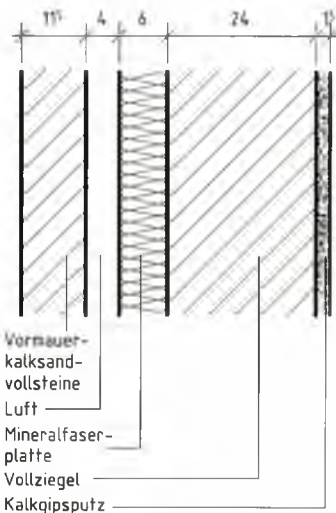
/2: Zweischaliges Mauerwerk mit Wärme-dämmschicht
